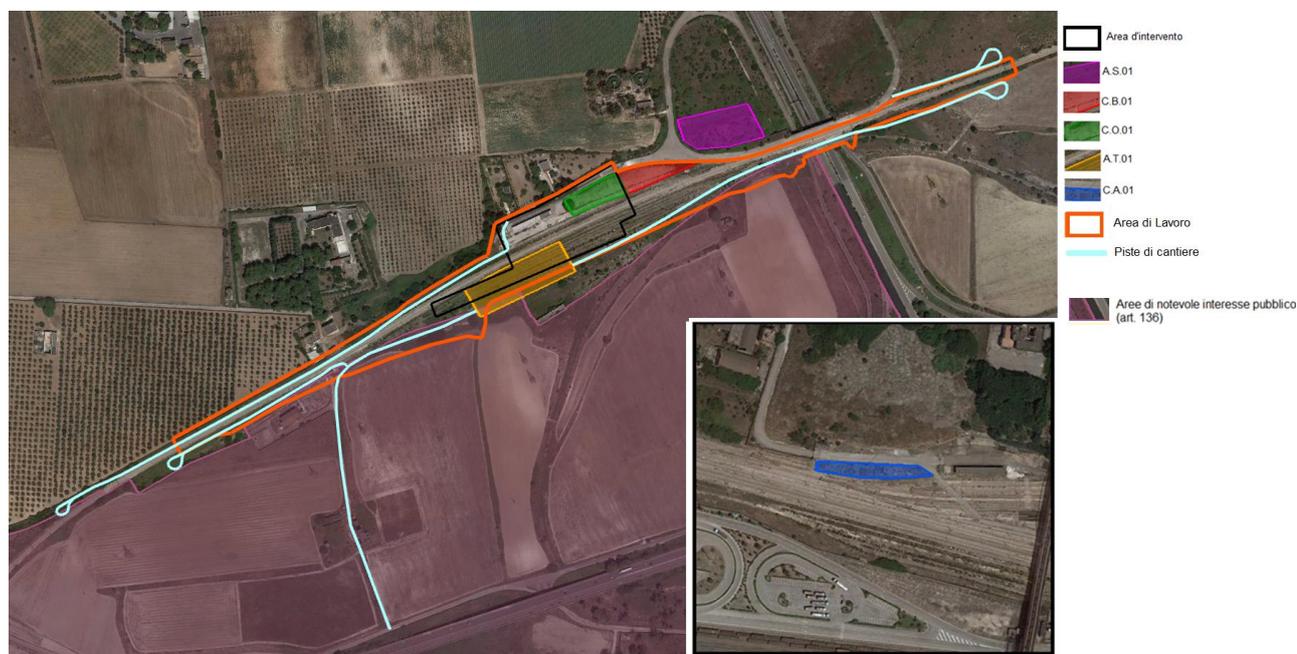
Localizzazione dell'area d'intervento e delle aree di cantiere rispetto il vincolo
